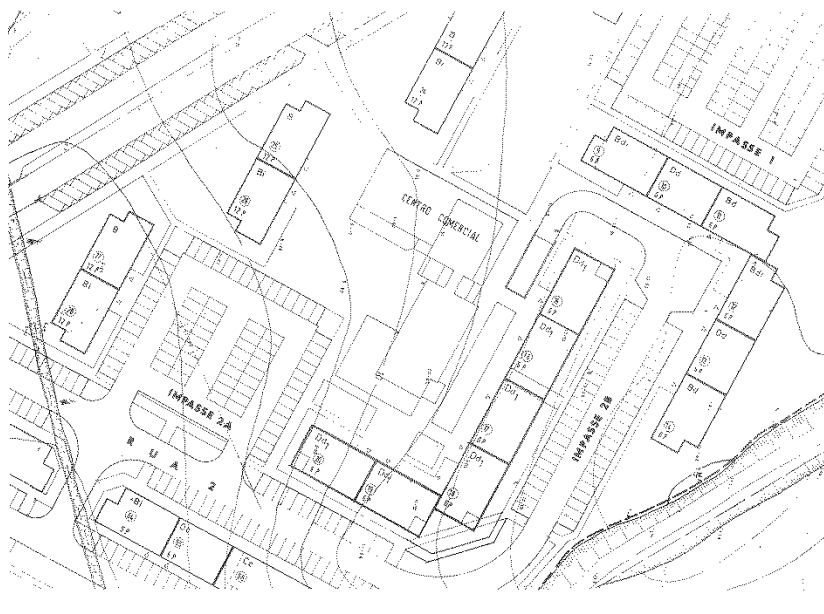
Fig. I | Cópia de Planta original da Urbanização da Barrada (CMA, 2018).
